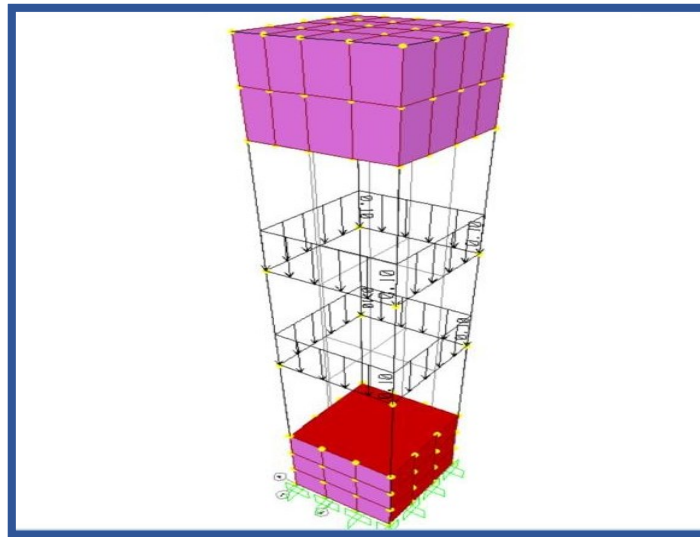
Aplicación de carga viva 0.10 ton/m2 en losa superior tanque elevado
